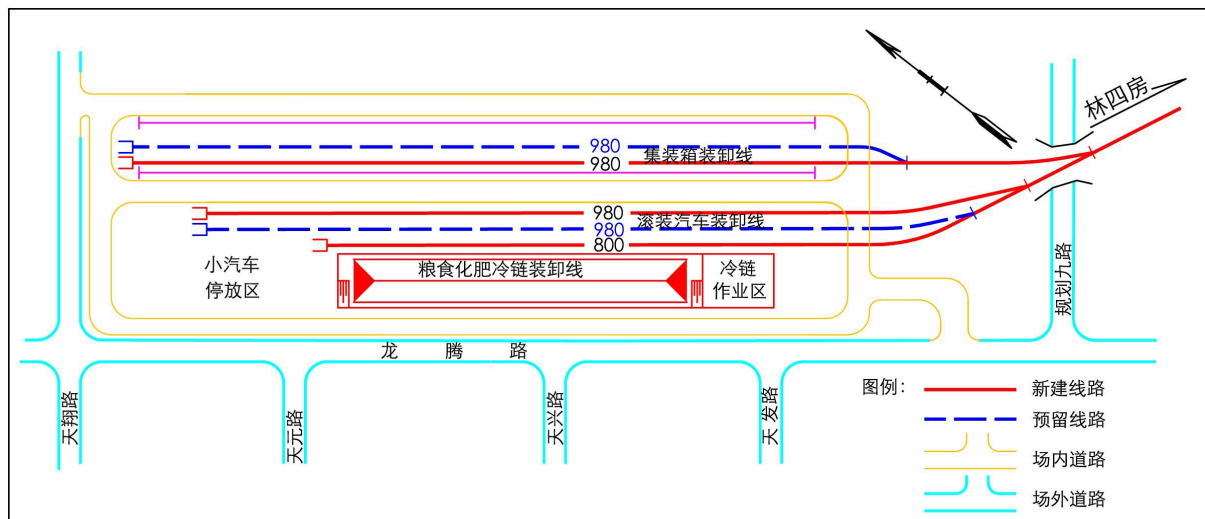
龙腾路北侧设置装卸场平面布置示意图
